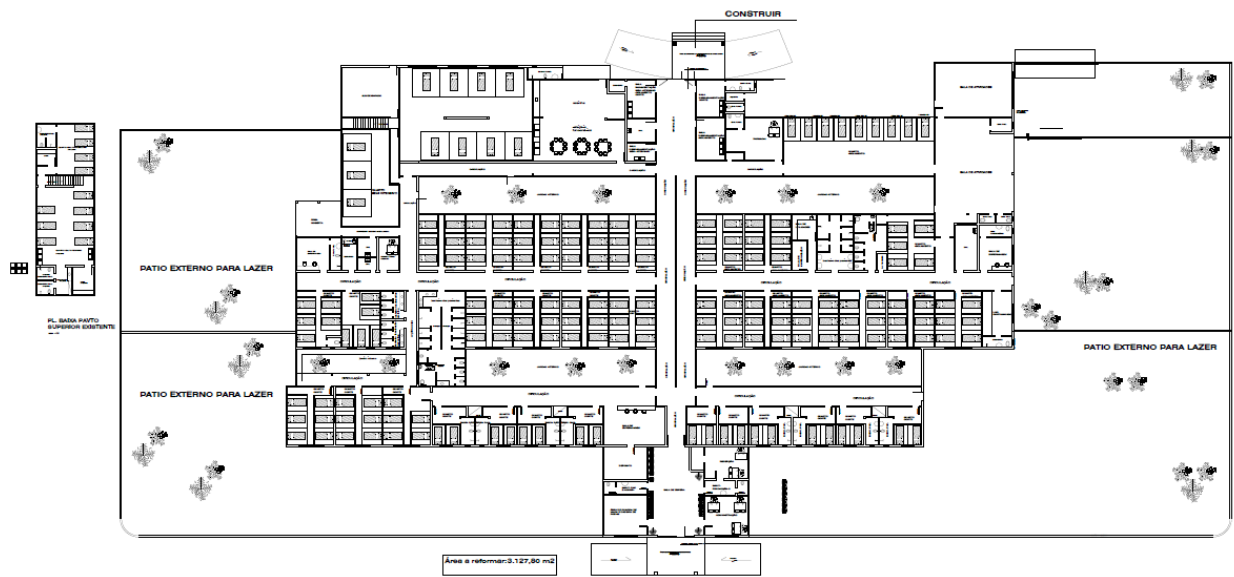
Planta baixa da Casa de Saúde. (Fonte: Dos Autores 2020).
